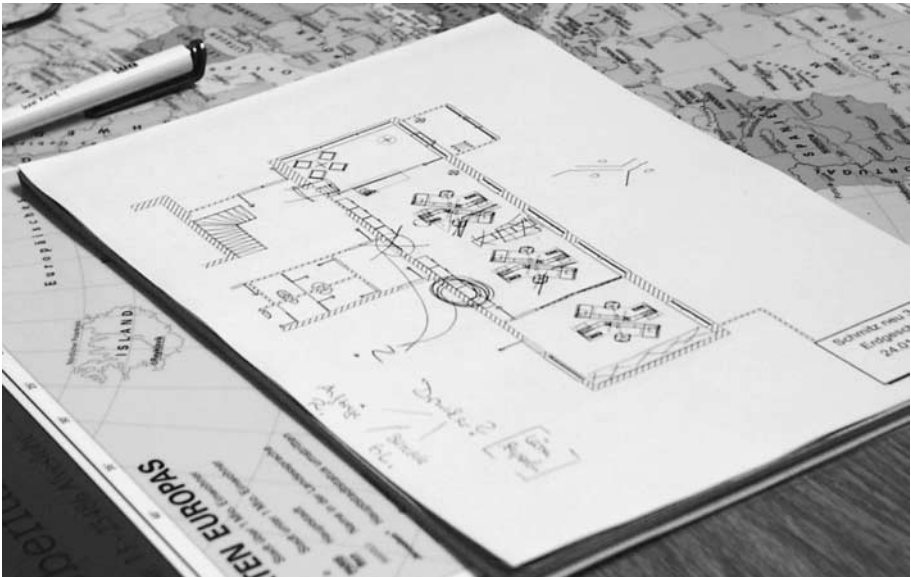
Grundrisszeichnung mit Anmerkungen
